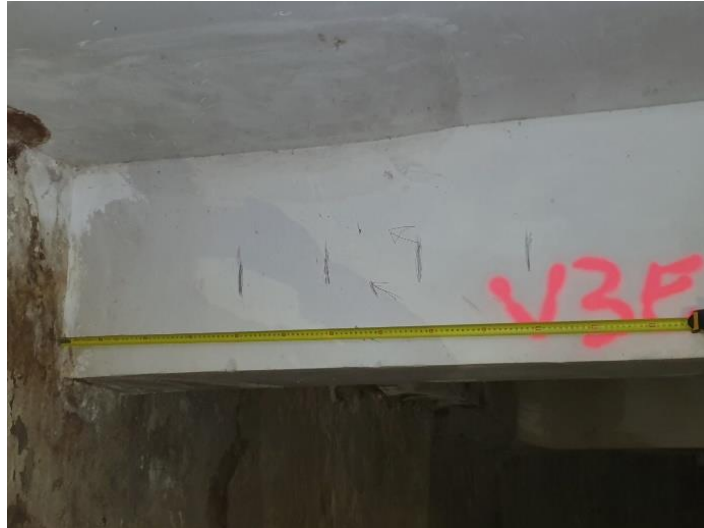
Pachometría realizada junto al apoyo de la viga en el muro de mampostería
